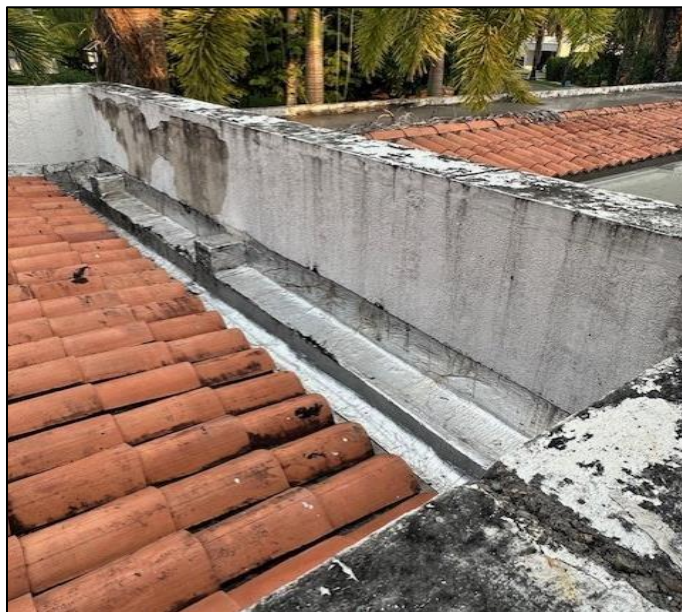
Fotografía detalle del estado de la alfajía y cubierta primer piso. (Fuente propia)
